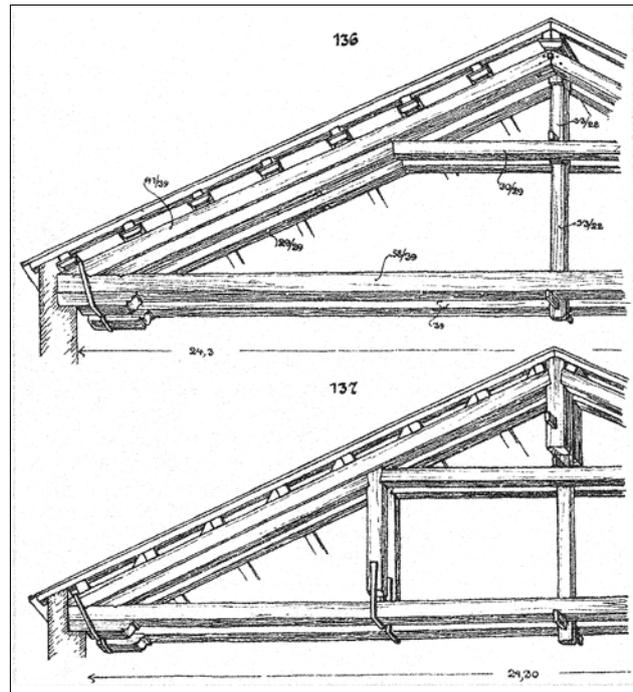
Gegenüberstellung der Konstruktionen von Pfetten- und Sparrendach.
